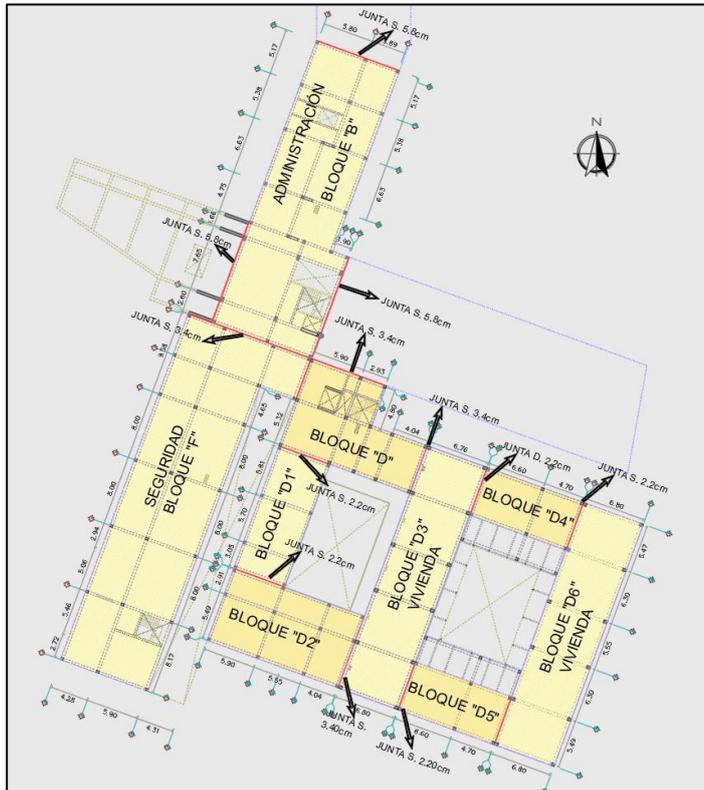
Planta de Bloques Estructurales y sus Juntas de Dilatación.
